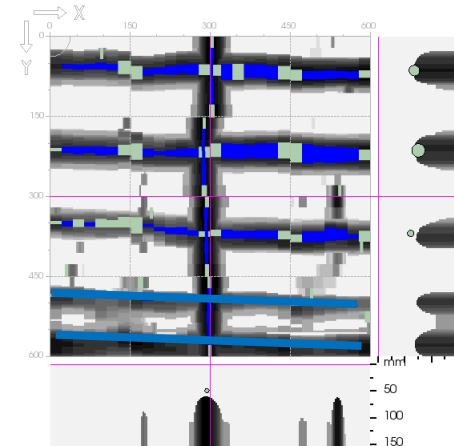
Poutre Pt02 – Travée 3 à mi-travée
